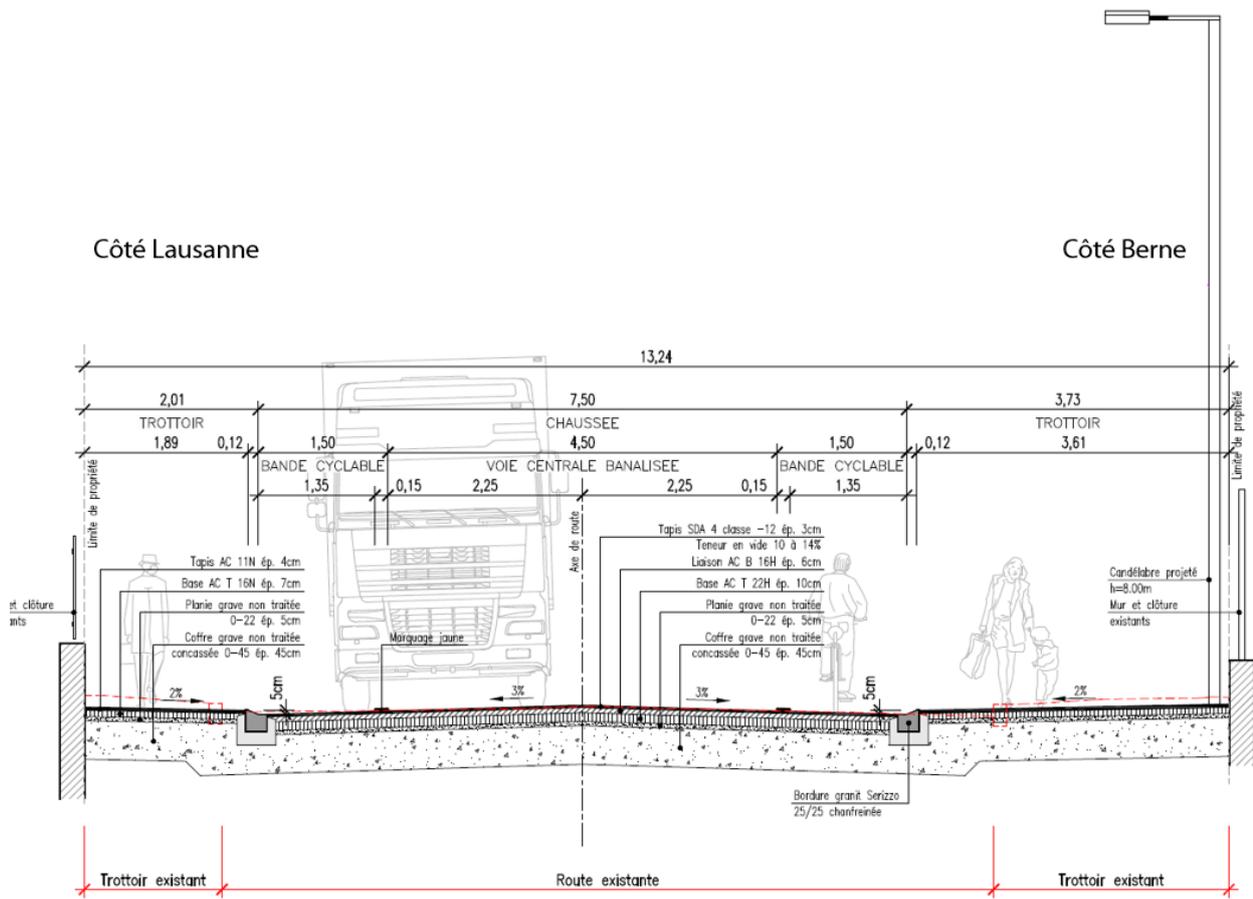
Gabarit de chaussée réaménagé projeté, profil type du réaménagement de l'Avenue Général Jomini (sans arborisation)
